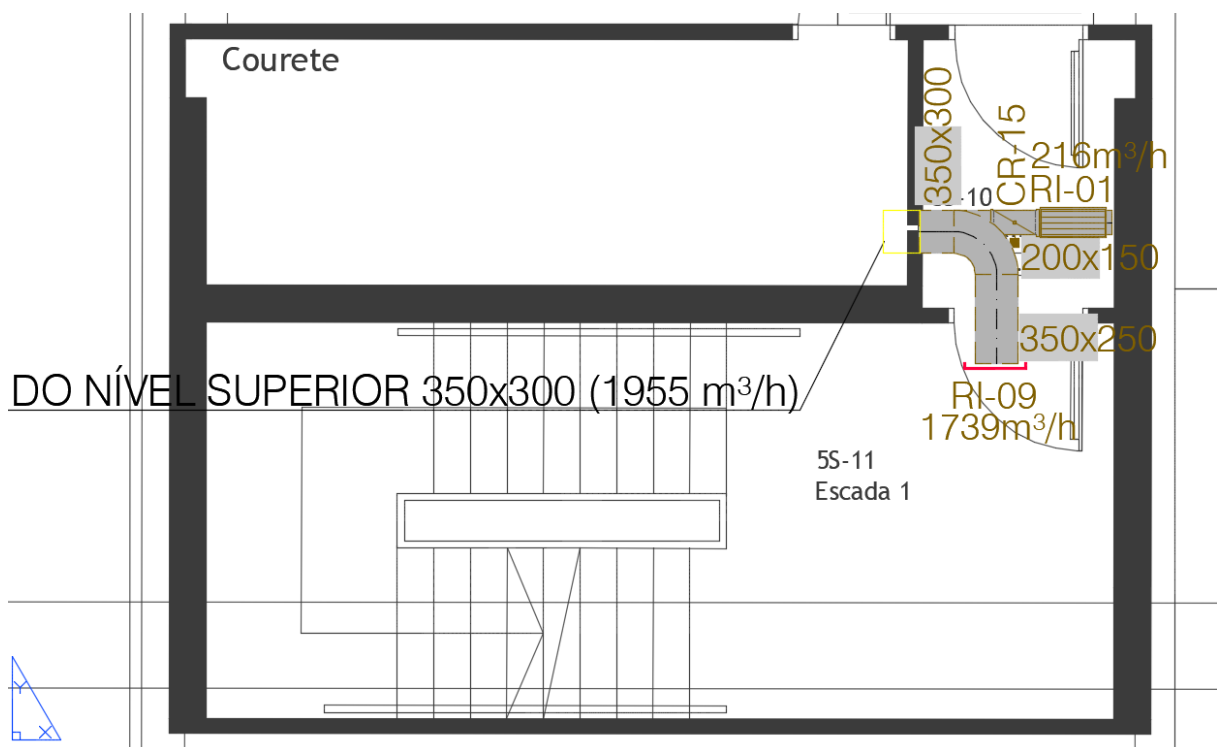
Caixa de escada 1, em planta, do piso -5 – HCD Expansão
